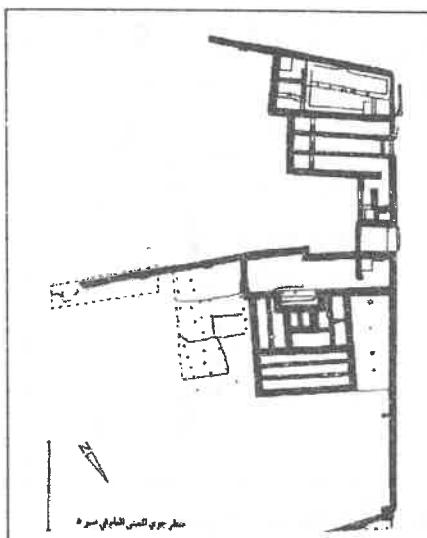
مخطط منزل مستطيل من موقع خراب سهل ذمار عن:
